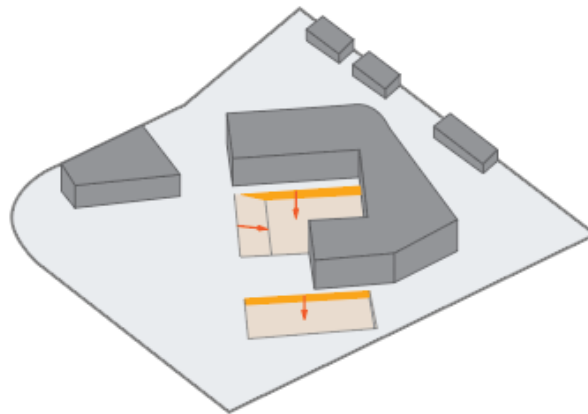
Subsuelo y planta baja libre. (Torres, C. 2022)
